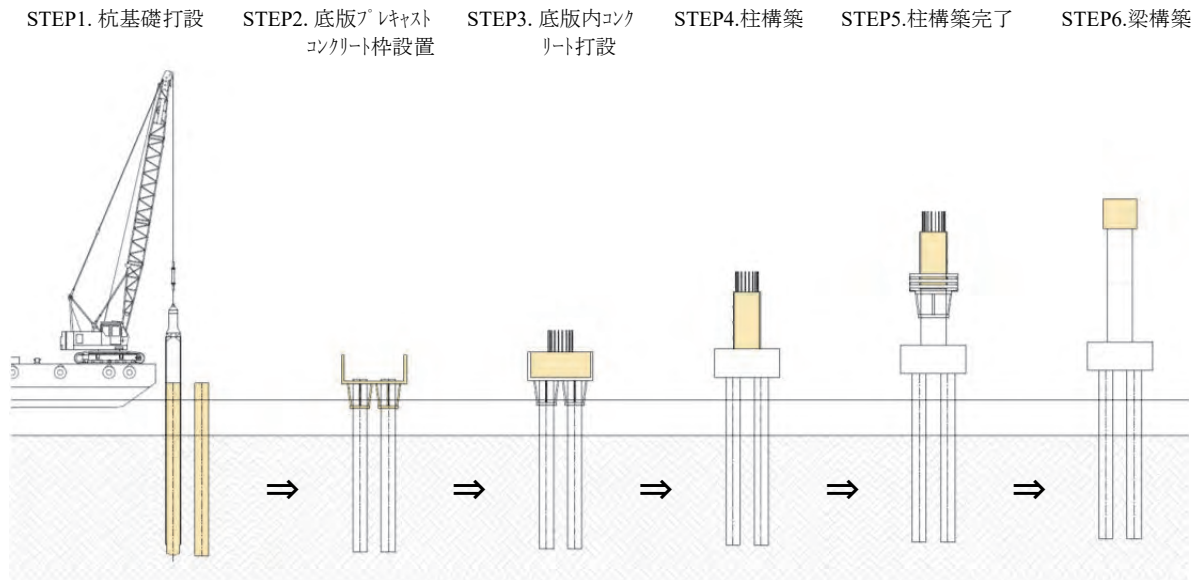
栈橋部下部工の施工ステップ (パイルキャップタイプ)
